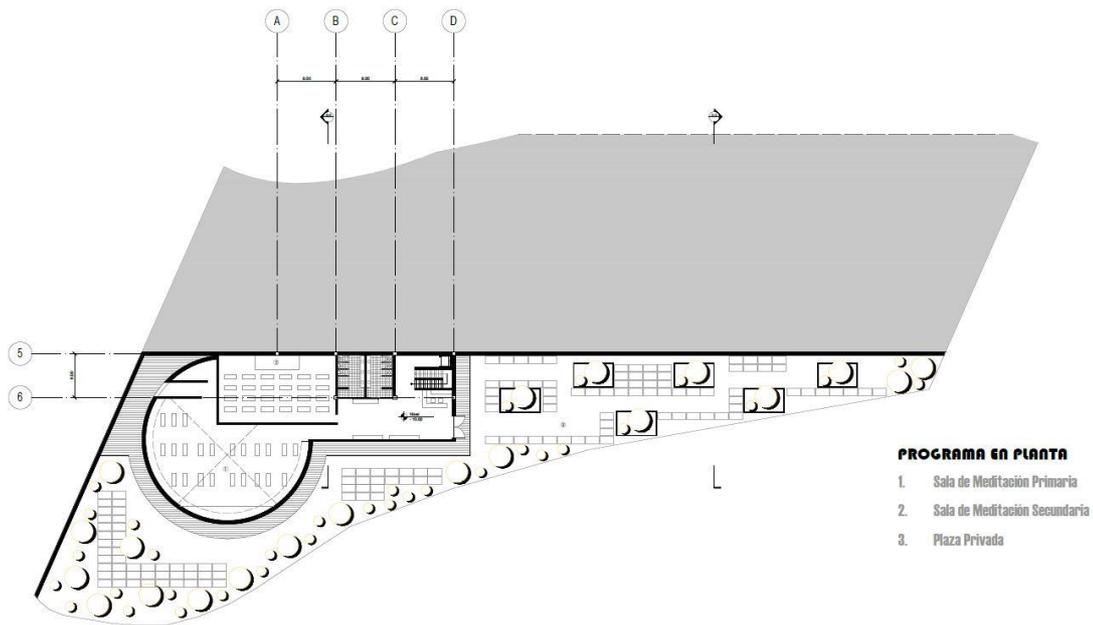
Planta Segunda N+ 9.40. Elaboración propia.
